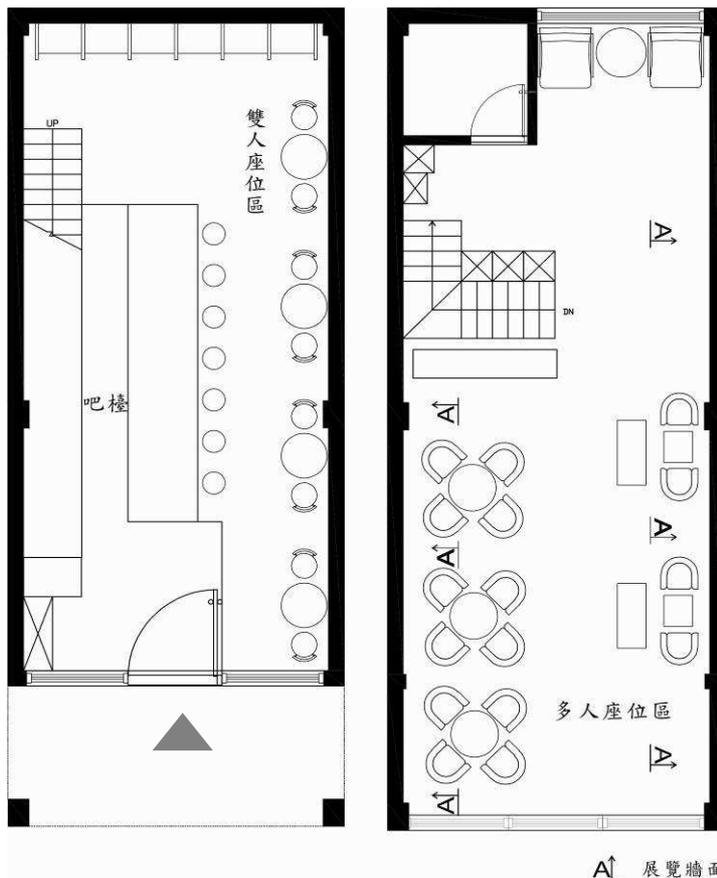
6Café5160 左：1F 平面圖 右：2F 平面圖
